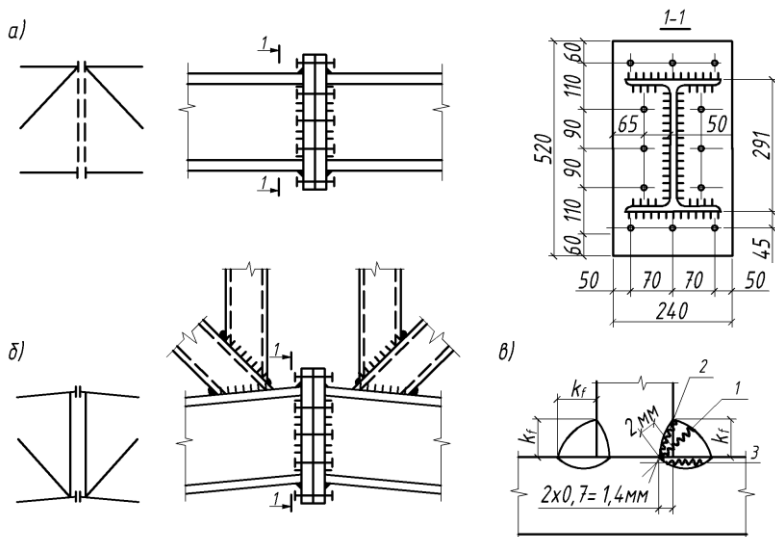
Укрупнительные узлы балочных ферм на фланцах
